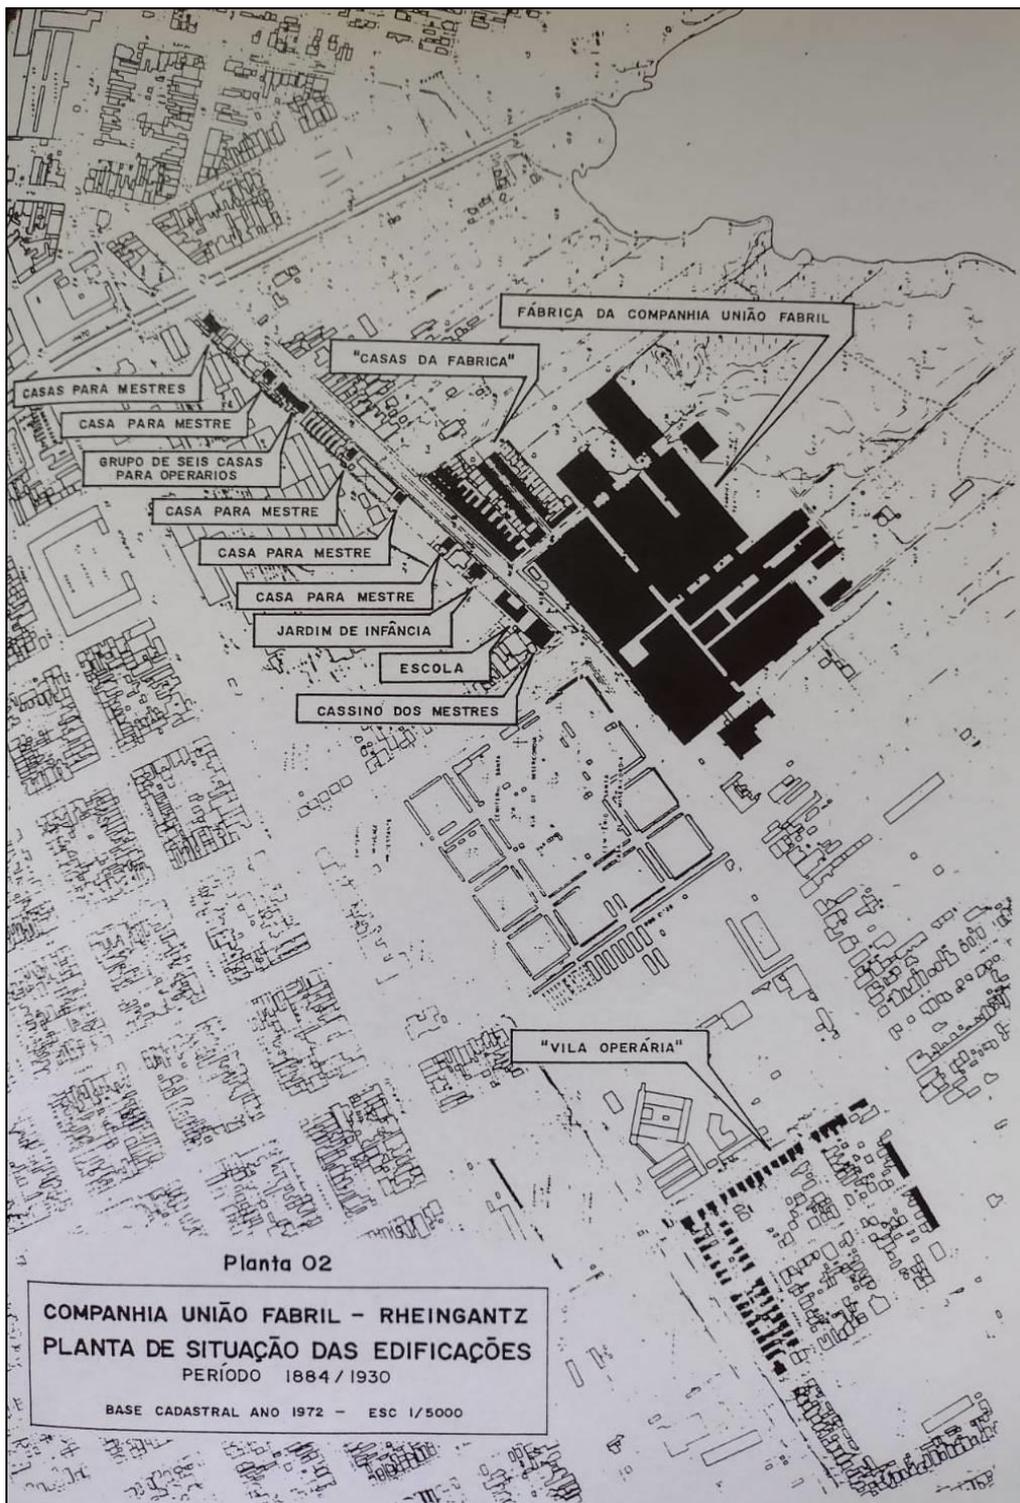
planta de situação das edificações da Companhia União Fabril – Rheingantz (1884/1930).
